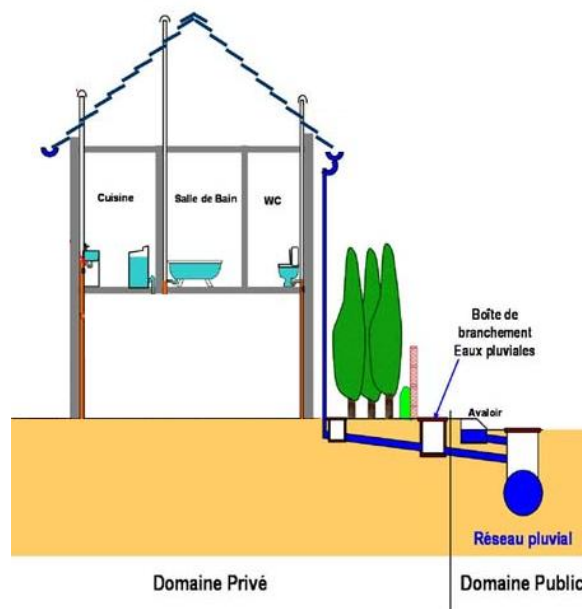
Vue en coupe d'un raccordement individuel au réseau pluvial collectif
